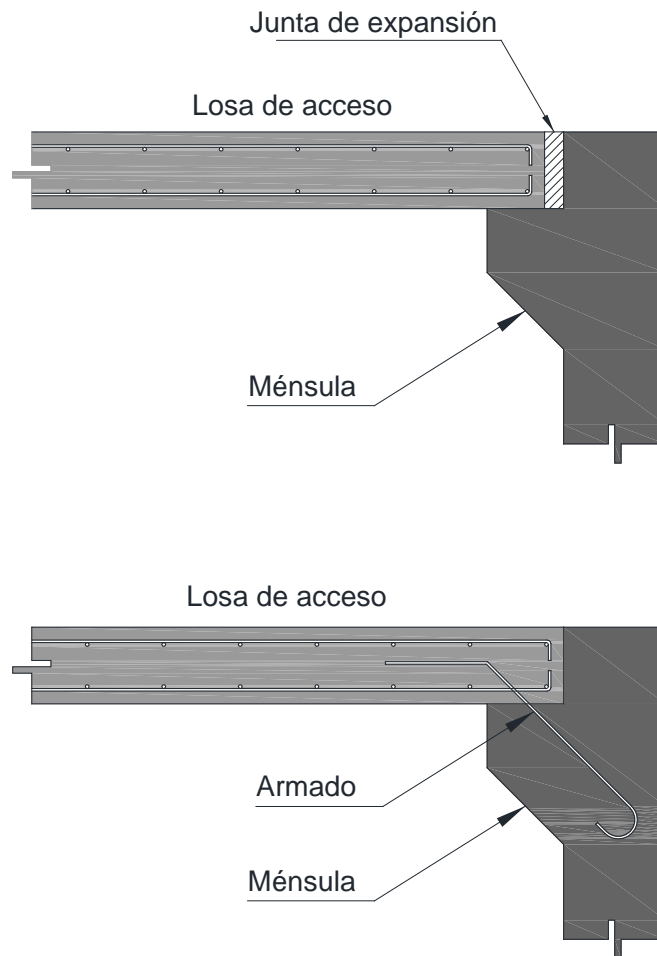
Detalles de conexión típicos de la losa de acceso al estribo. En el primer caso se muestra la losa simplemente apoyada y con una junta de expansión entre la losa y el estribo. En el segundo caso se muestra el uso de acero de refuerzo para conectar la losa de acceso al estribo.
